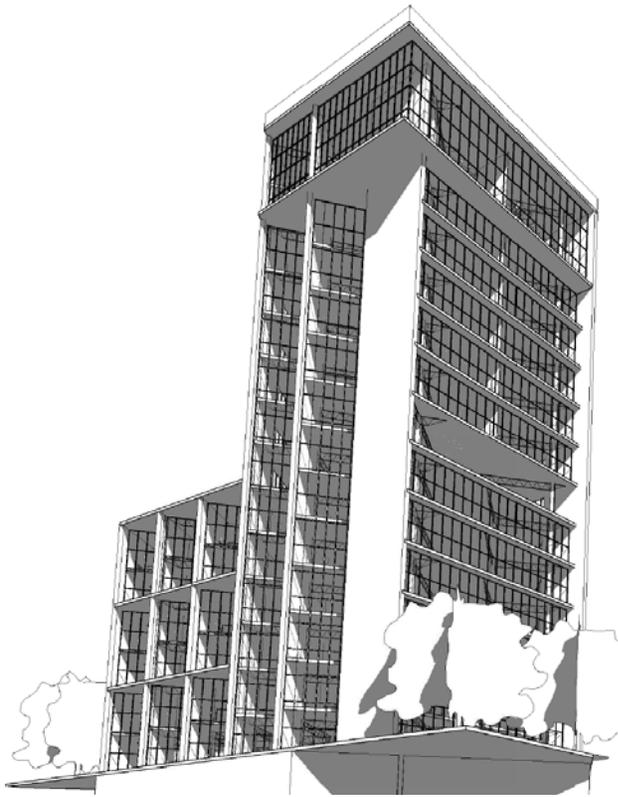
estudio de fachada de propuesta 5, vistas noreste y noroeste.
